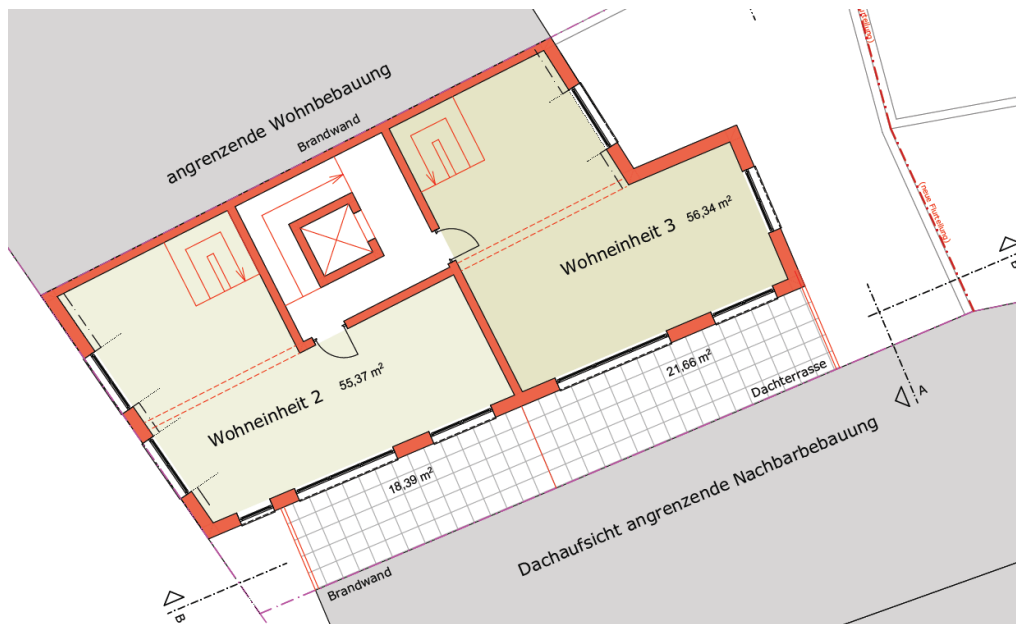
1. Dachgeschoss mit den WE 2 u. WE 3, Voranfrage [REDACTED] v. 08.12.2025
